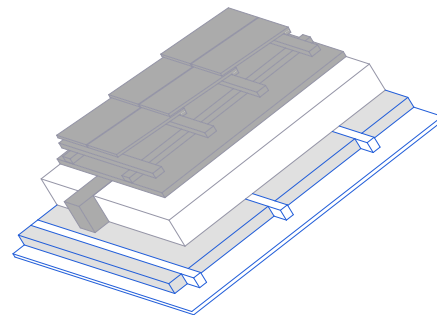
Dämmung des unausgebauten Dachstuhls im Hauptgebäude
